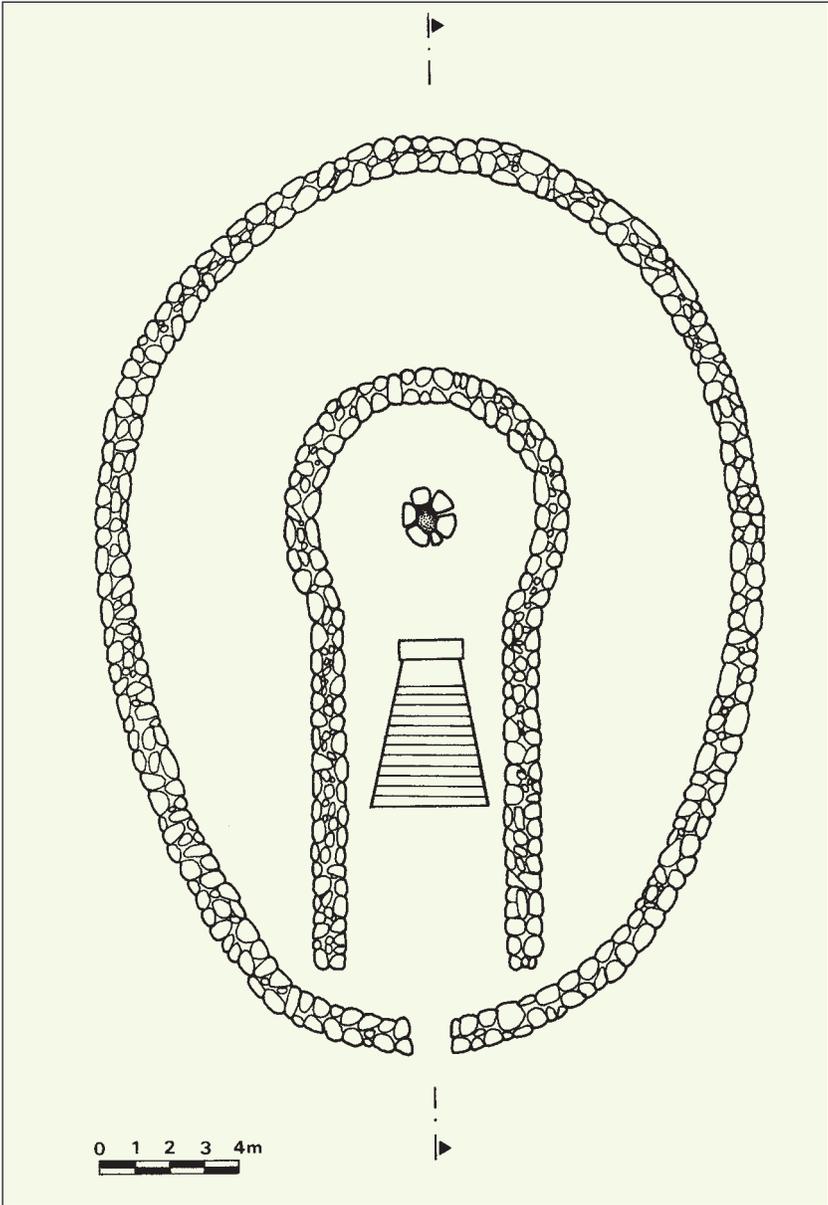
Schizzo planimetrico del pozzo sacro di Santa Cristina.
